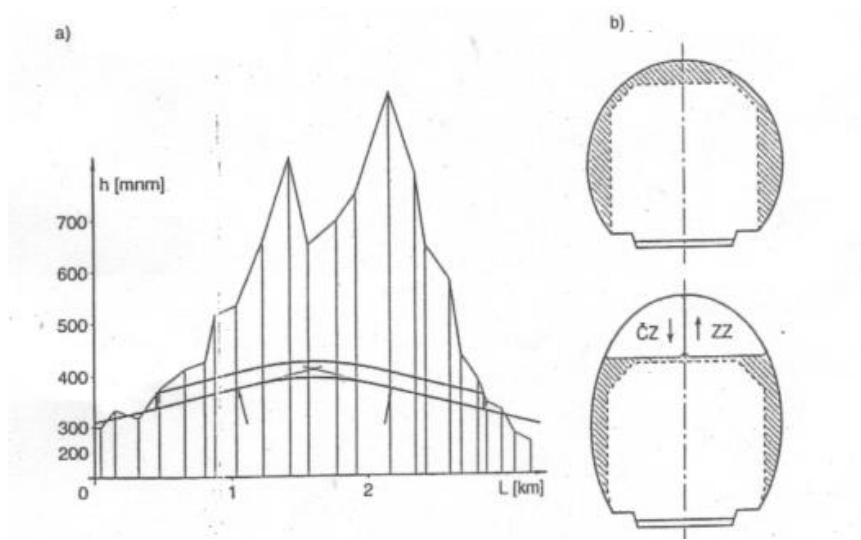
Prerja për së gjati dhe e tërthortë e tunelit
